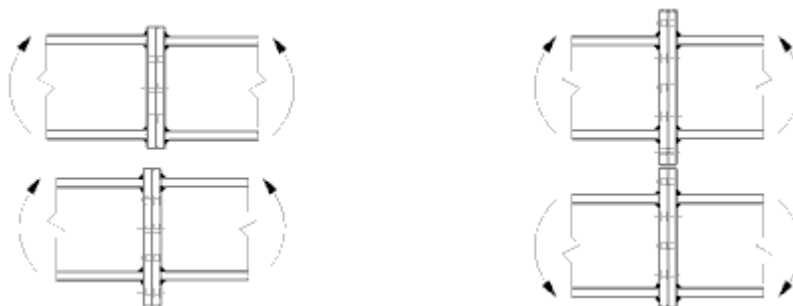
Стыки балок на болтах с приваренными опорными фланцами
